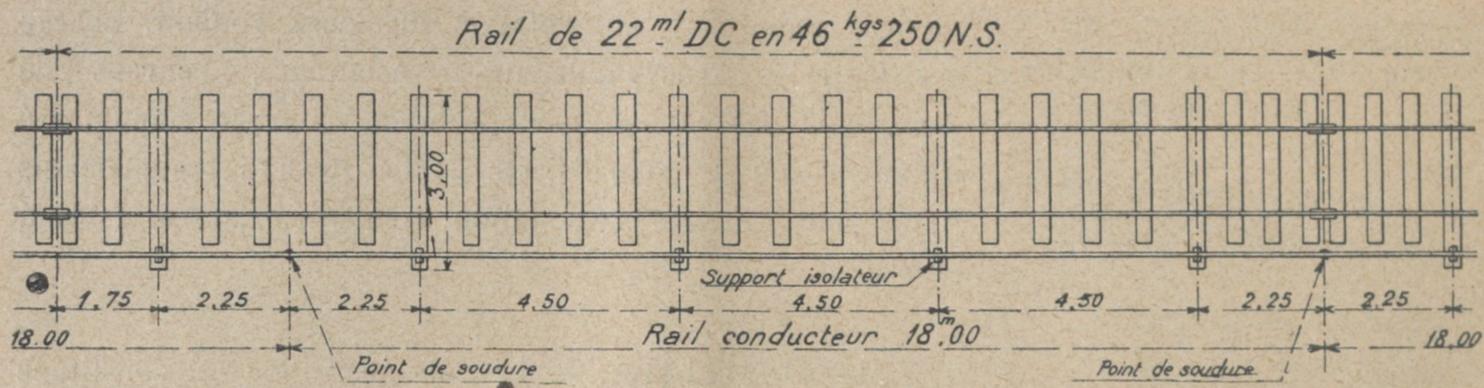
PLAN DE POSE DE LA VOIE ÉQUIPÉE ÉLECTRIQUEMENT.
